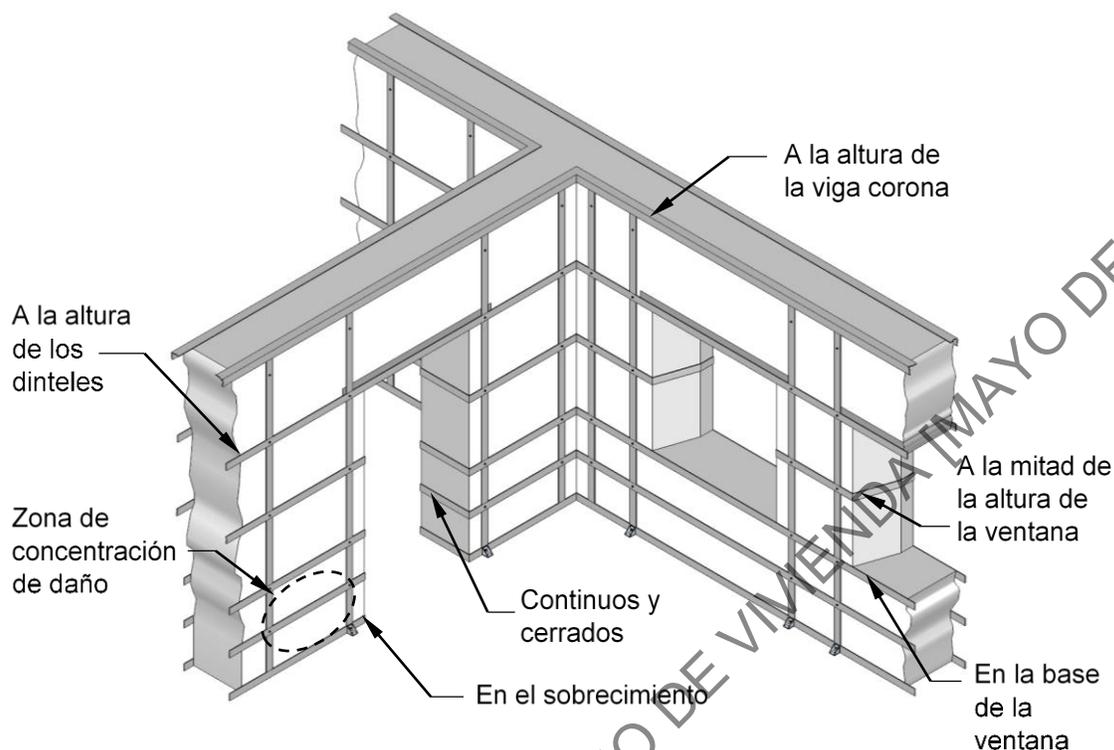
Sistema de reforzamiento con entramados de madera, acero, plástico o similar.
